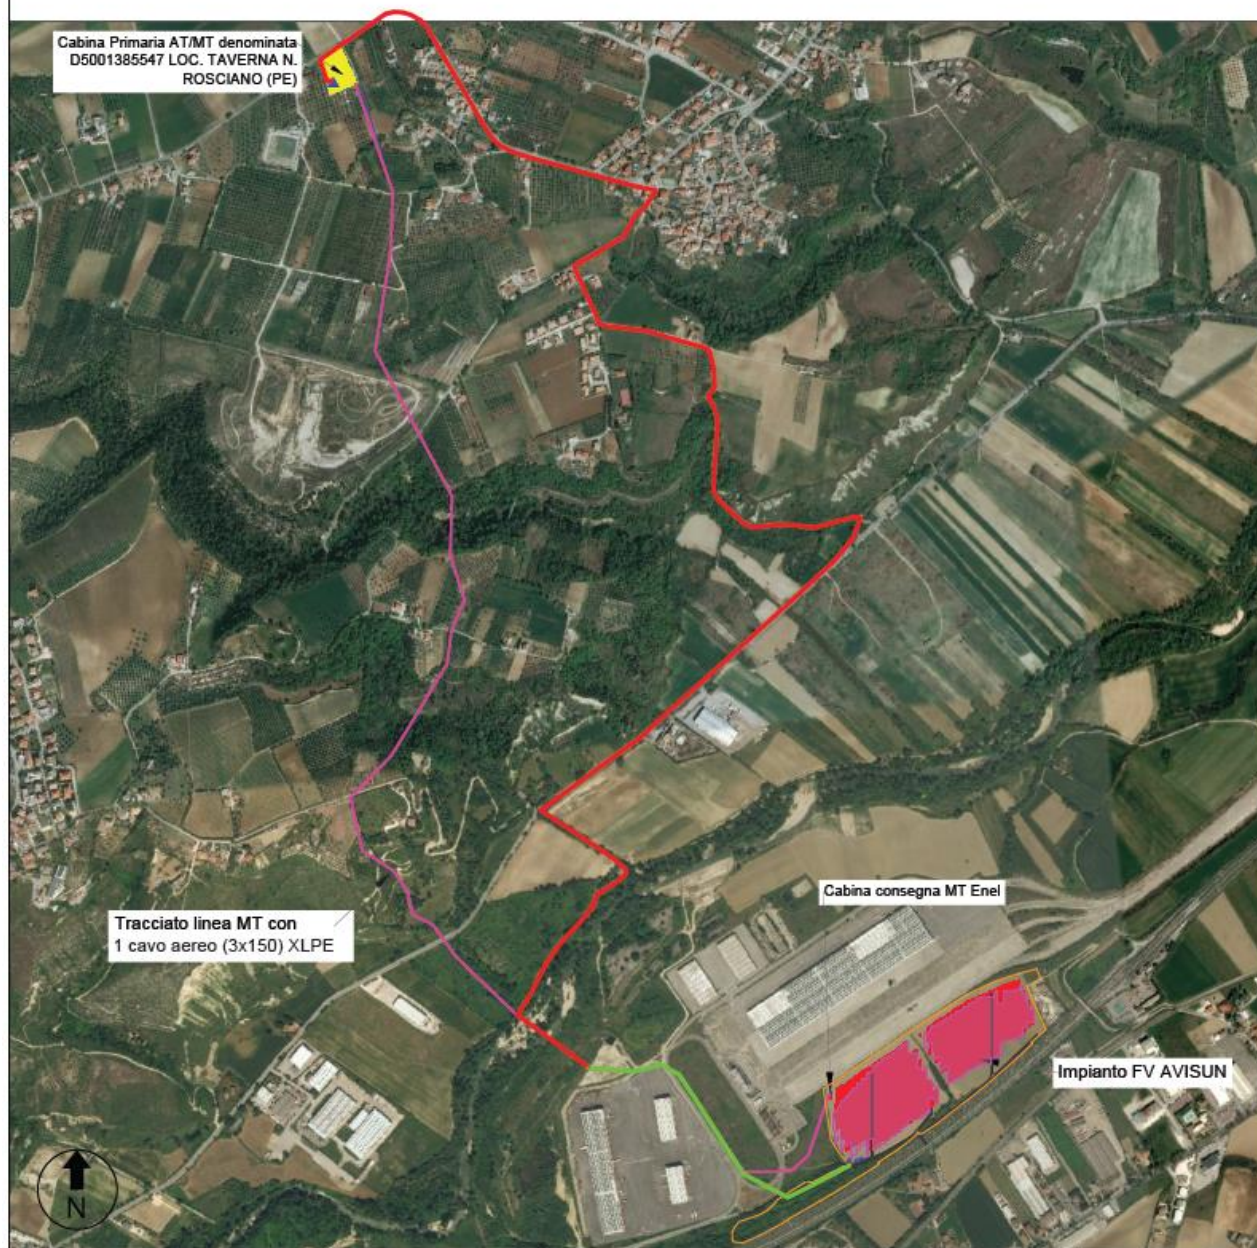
Sovrapposizione su ortofoto tra progetto autorizzato (elettrodotto in magenta) e progetto di variante (elettrodotto aereo in verde e cavidotto interrato in rosso)
